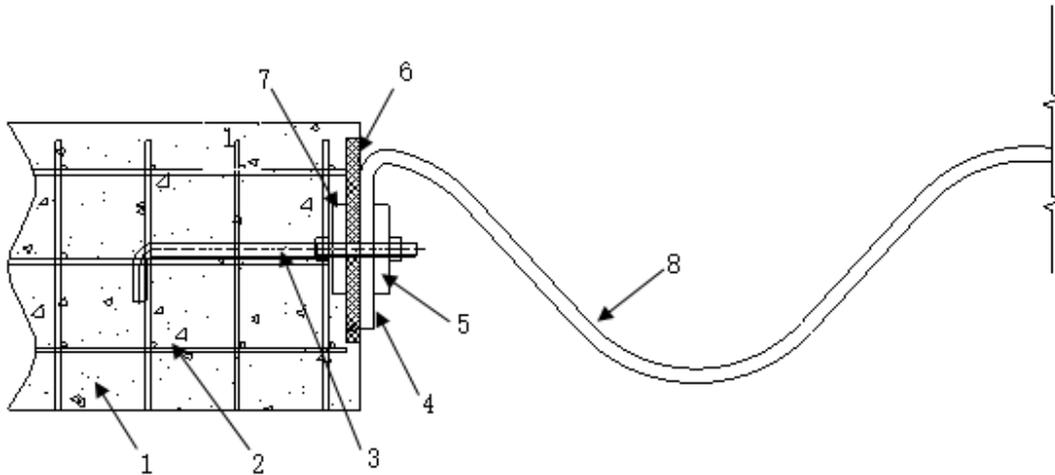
钢结构管廊与钢筋混凝土结构连接结构示意图
